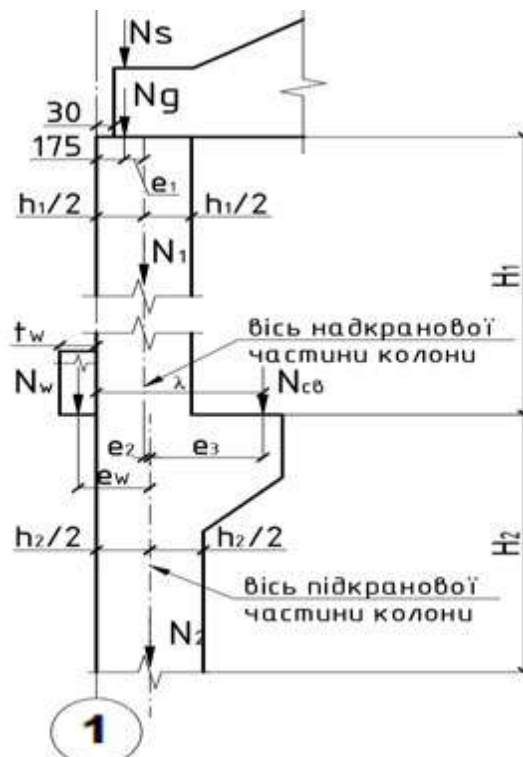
Розрахункова хема колои крайного ряд по осі «1»
